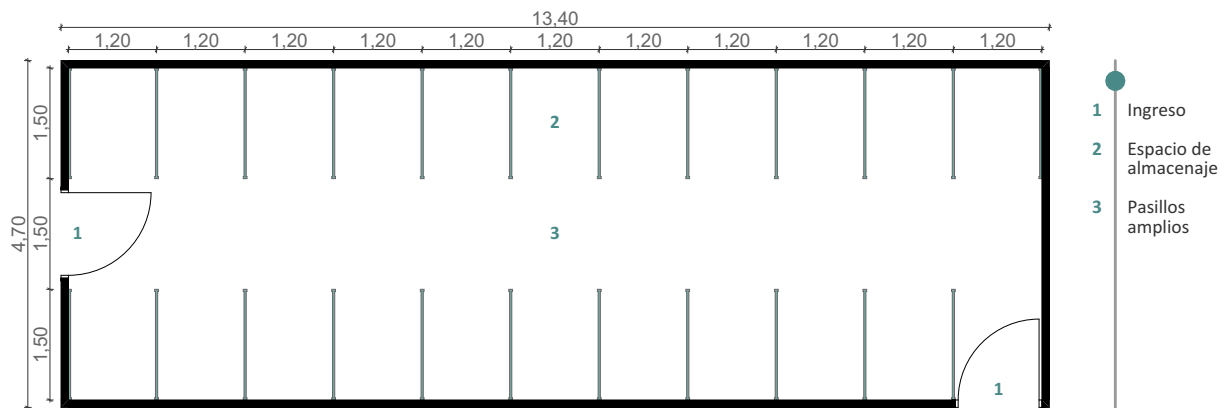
Planta de bodegas. Elaborado: Autores
